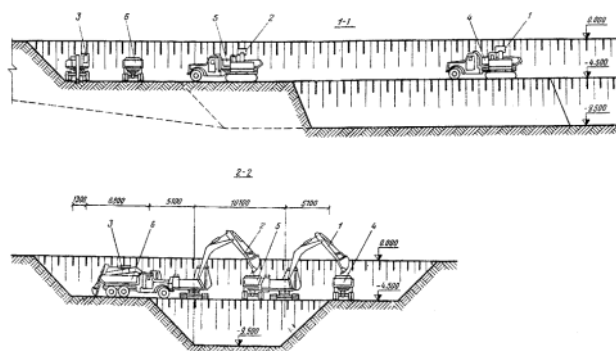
Схема разработки грунта в котловане до отметки - 9.500:
